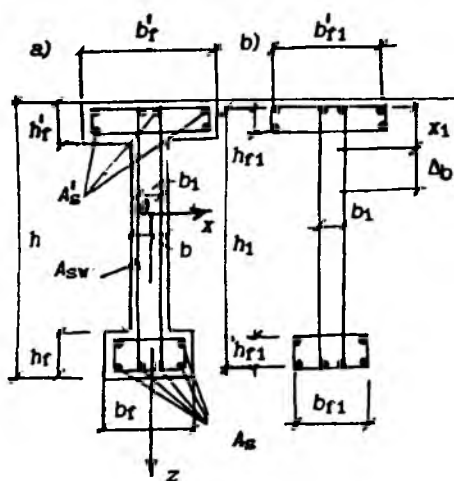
К определению напряжений в арматуре и бетоне элемента двутаврового профиля
